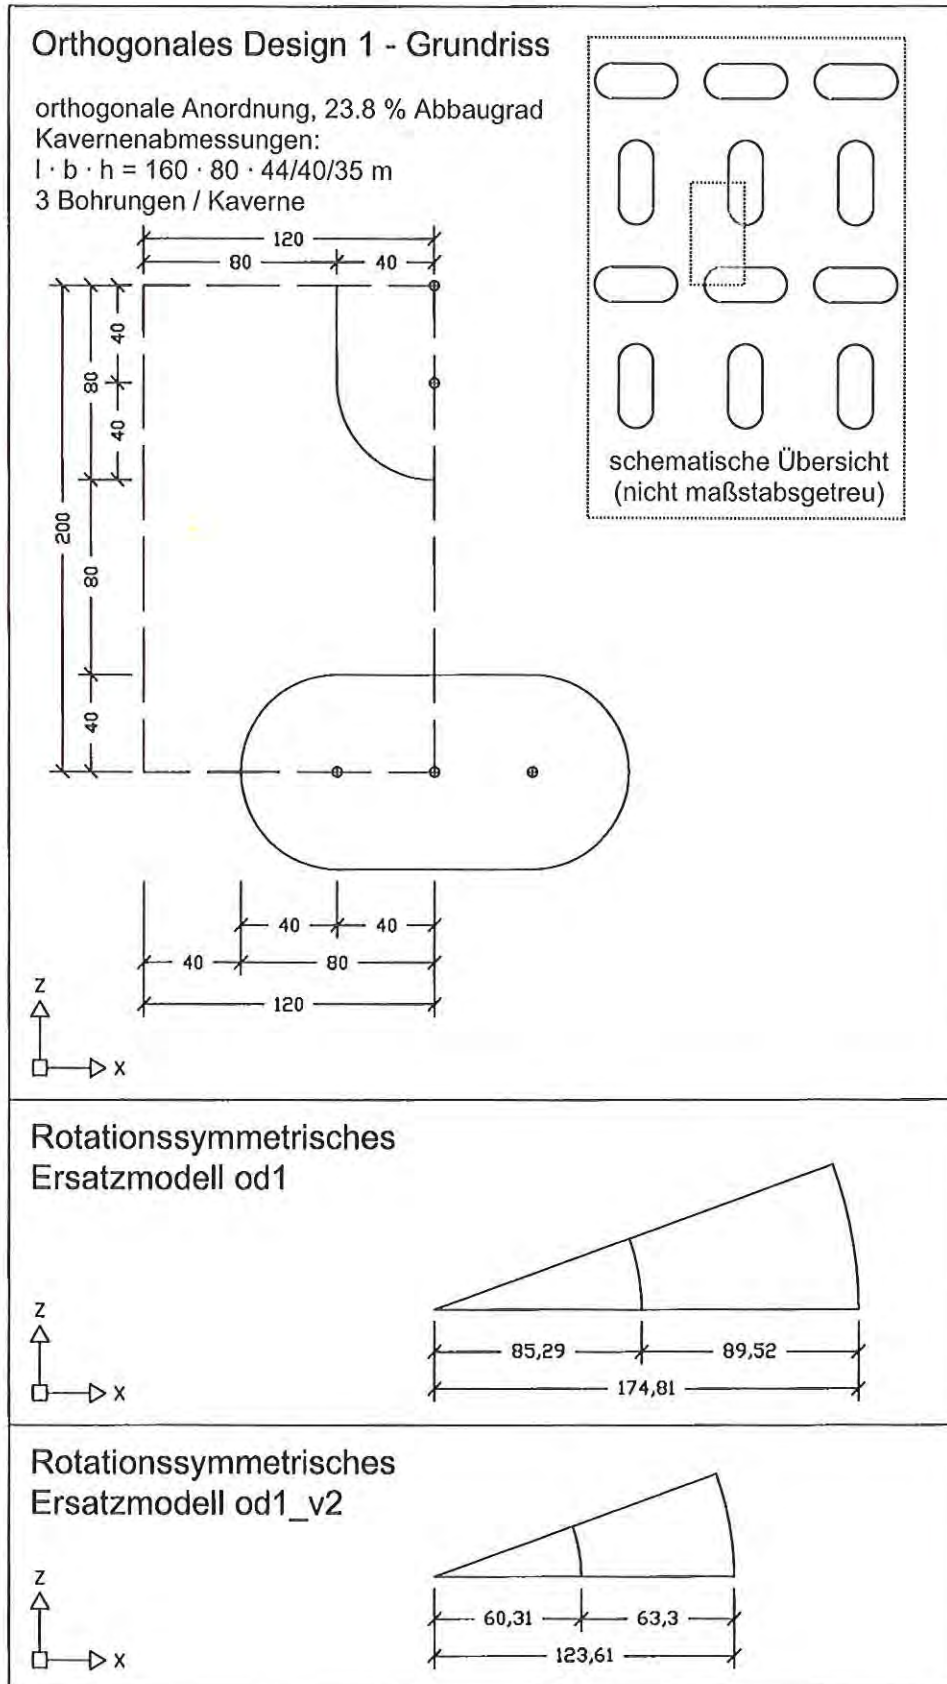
Orthogonales Design 1 – Grundriss und rotationssymmetrische Ersatzmodelle
